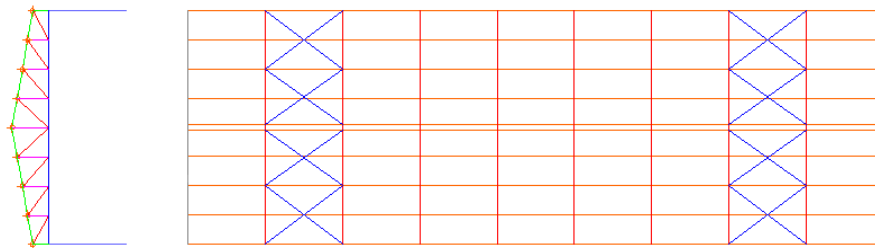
Contraventamento das duas fachadas da estrutura realizado automaticamente.
